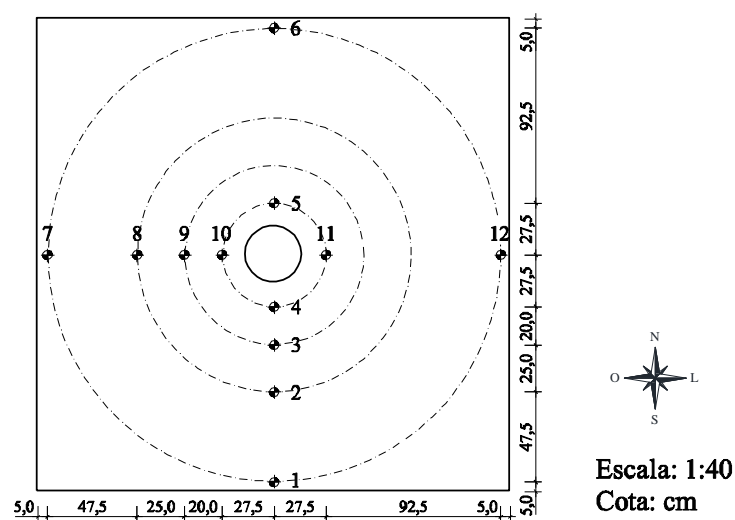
Posição dos LVDT's nas lajes – vista em planta
